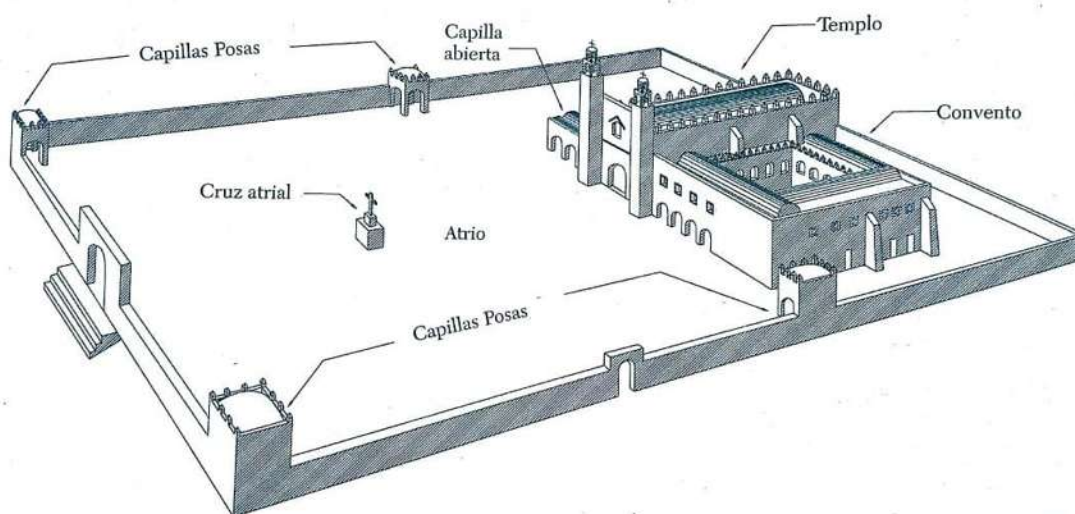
Elementos principales de un convento mexicano. (Los conventos mexicanos del siglo XVI: construcción, ingeniería estructural y conservación; autor: Roberto Meli Piralla.)
